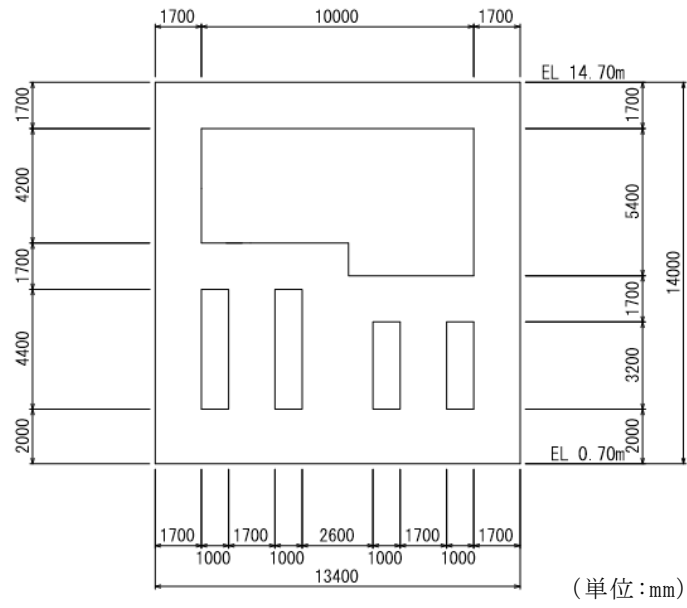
(2) 第 1 ベントフィルタ格納槽 断面図 (B-B 断面)
